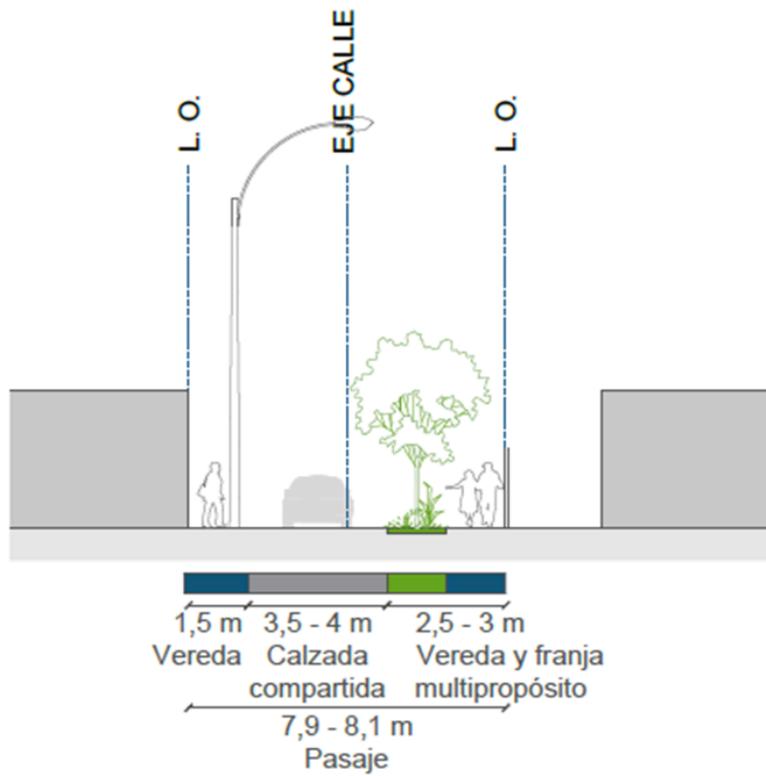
Perfil tipo. Situación propuesta Pasajes.
